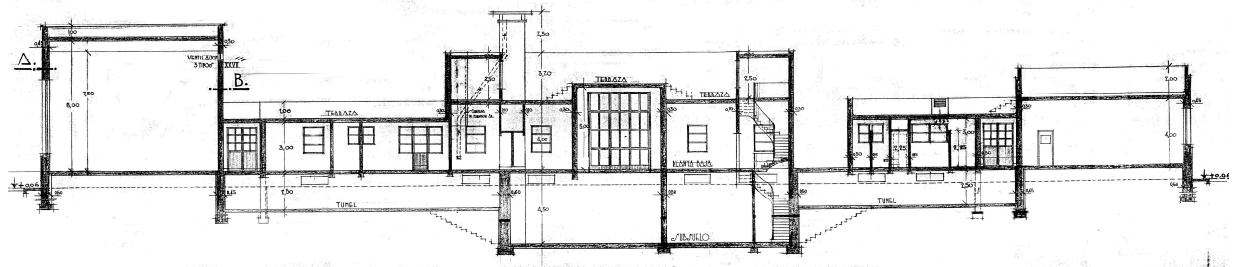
“Sección E.F.”, del plano “Cortes”, 1937. Ministerio de Obras Públicas, en Archivo LEMIT.
